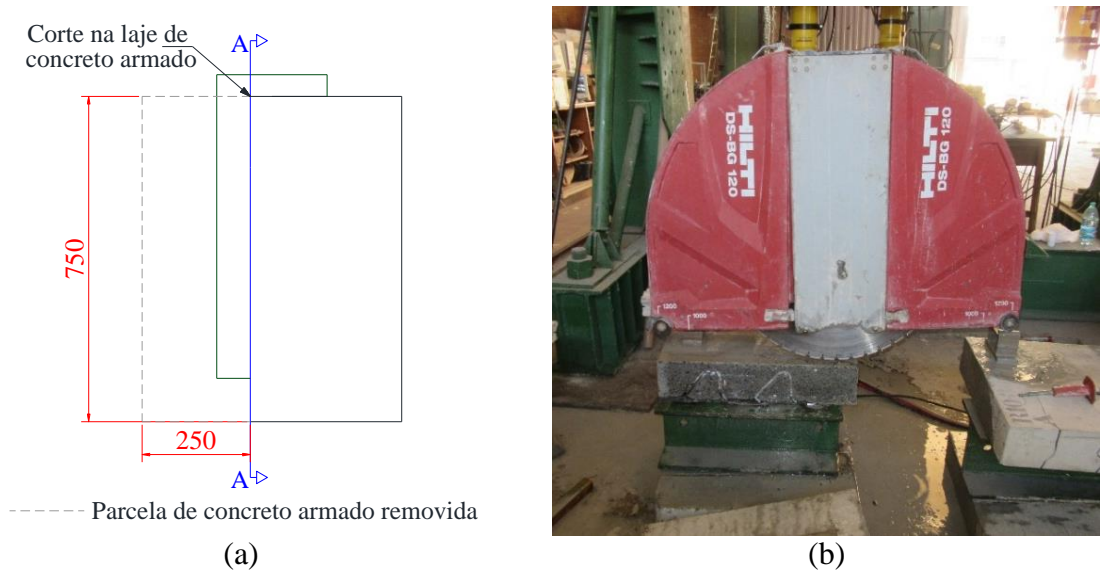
Corte dos modelos da segunda concretagem: (a) planejamento dos cortes; (b) equipamento utilizado no corte das lajes dos modelos.
